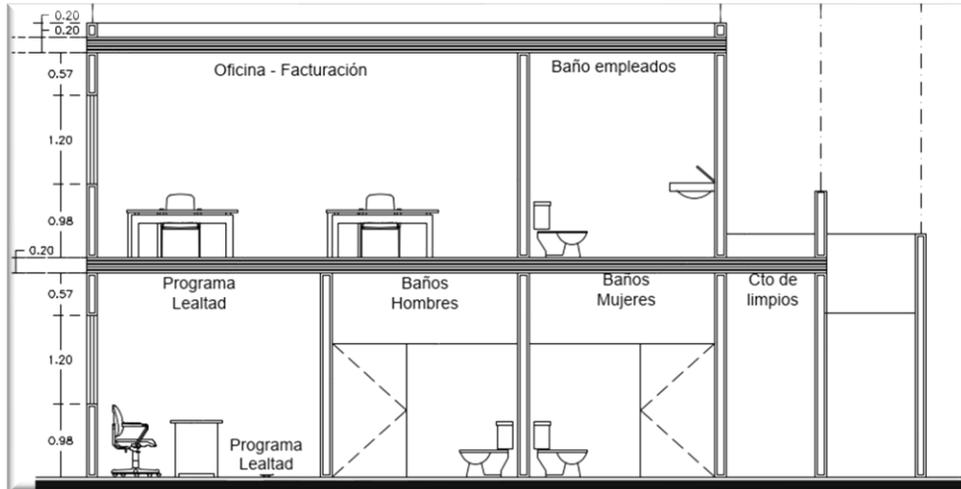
4 Vista frontal de baños públicos (planta baja) y oficinas (planta alta).
